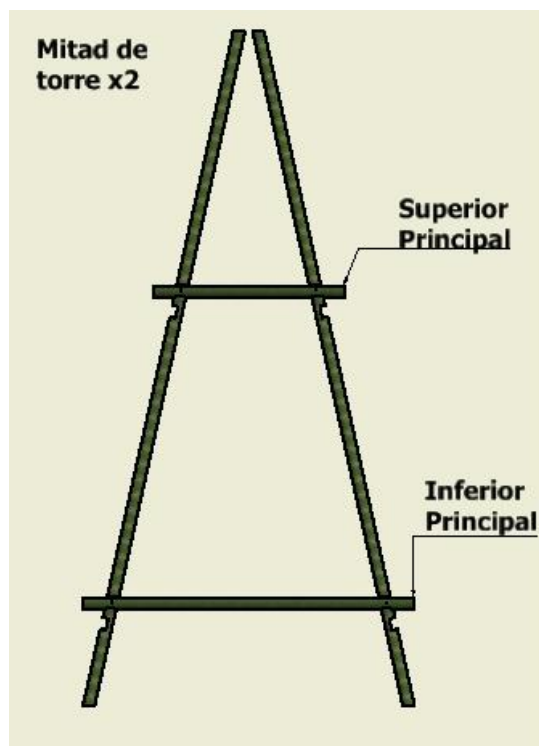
DETALLE DEL CORTE PARA LA VIGA SUPERIOR PRINCIPAL
